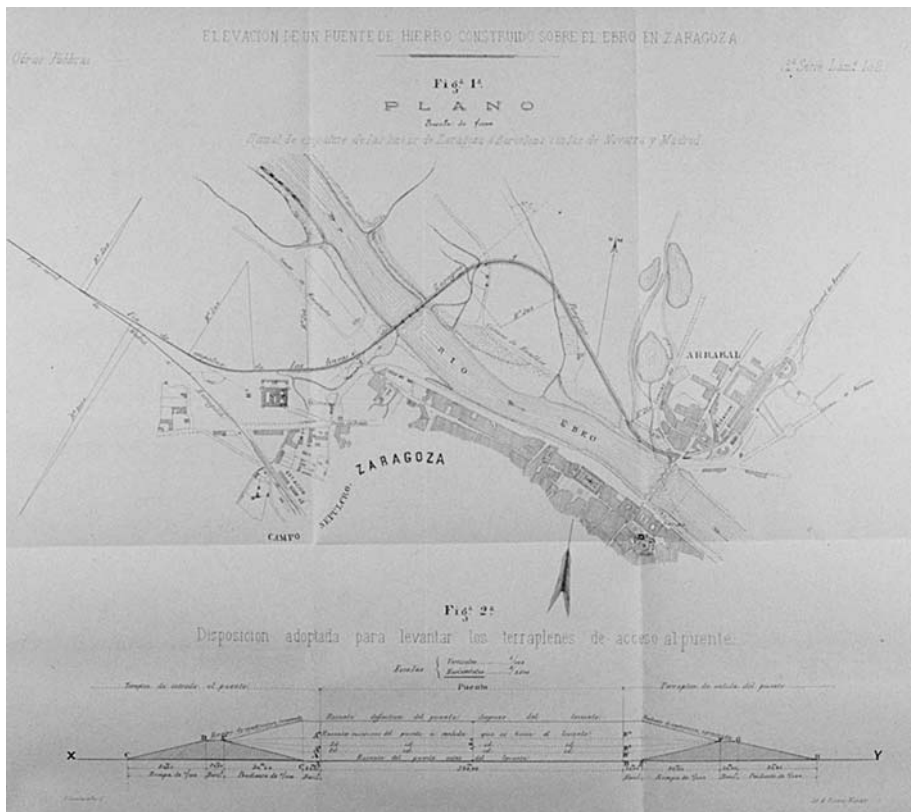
Elevación de un puente de hierro construido sobre el río Ebro en Zaragoza, 1880. Ramal de empalme de las líneas de Zaragoza a Barcelona con las de Navarra y Madrid.
